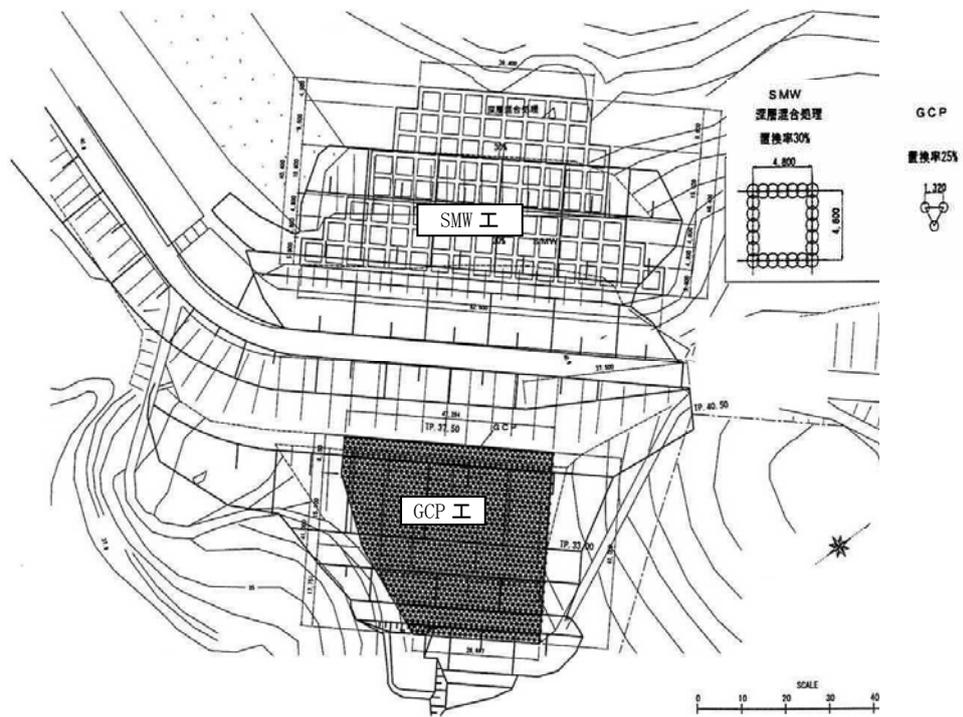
第2堰堤改修計画平面図⁴⁾
